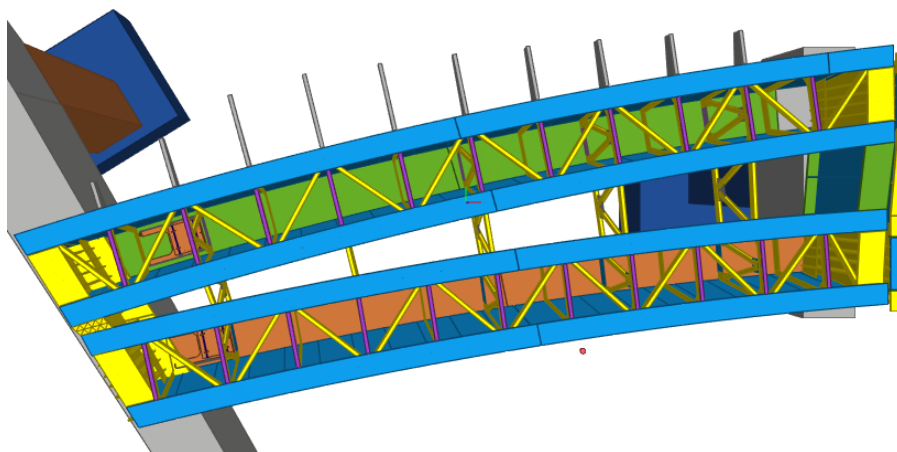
Planta de trabe 1-2 extradós con sus 10 piezas puente
